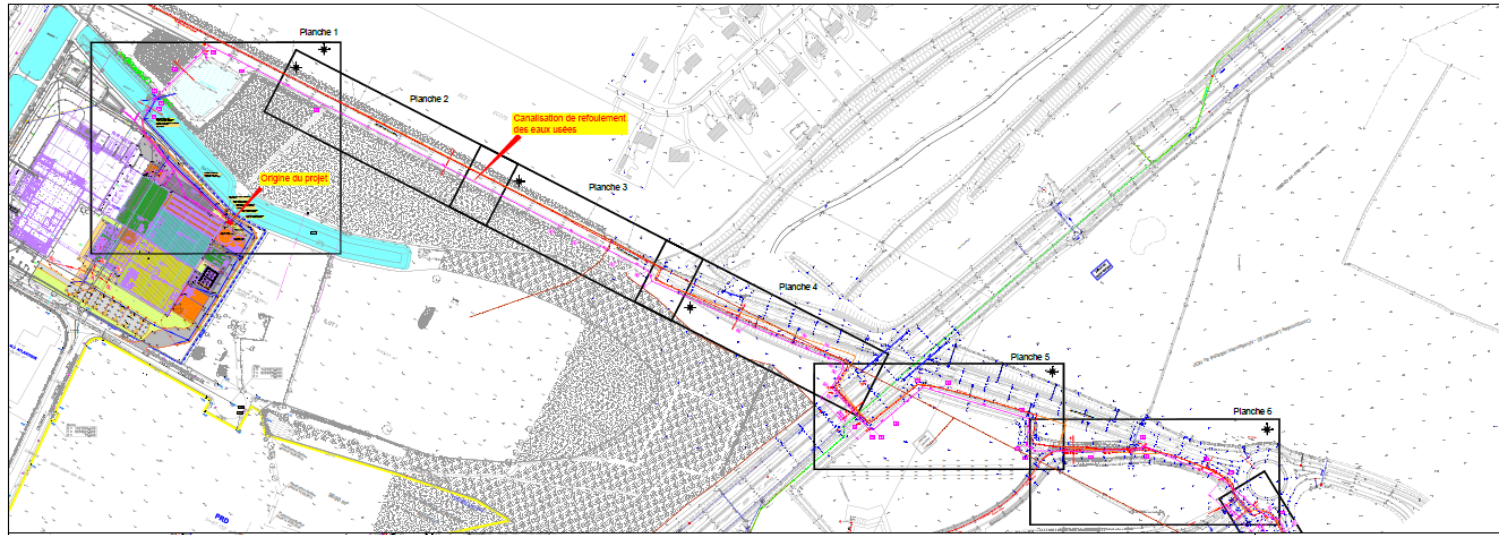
Vue en plan générale du tracé du projet de conduite de refolement – partie 2/2 (Source : Elcimai Environnement - PRO)
